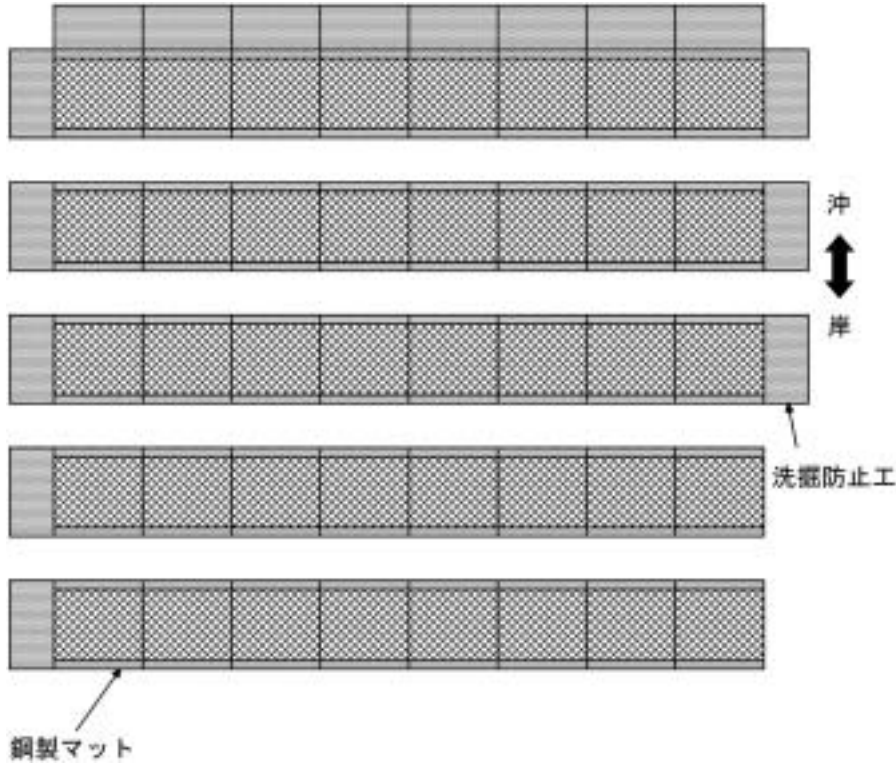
鋼製マット配置図 (逗子ヶ浜 期)
